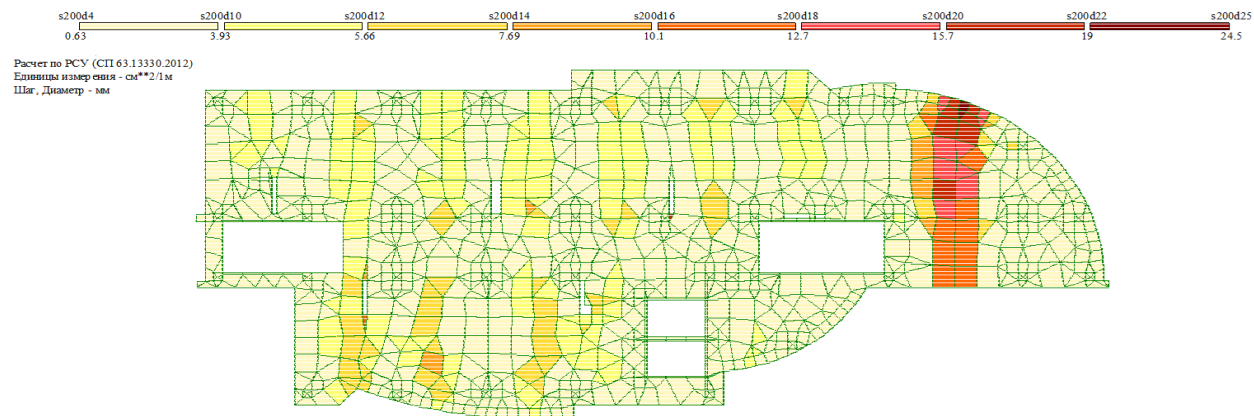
Армирование плиты перекрытия по X нижняя зона
